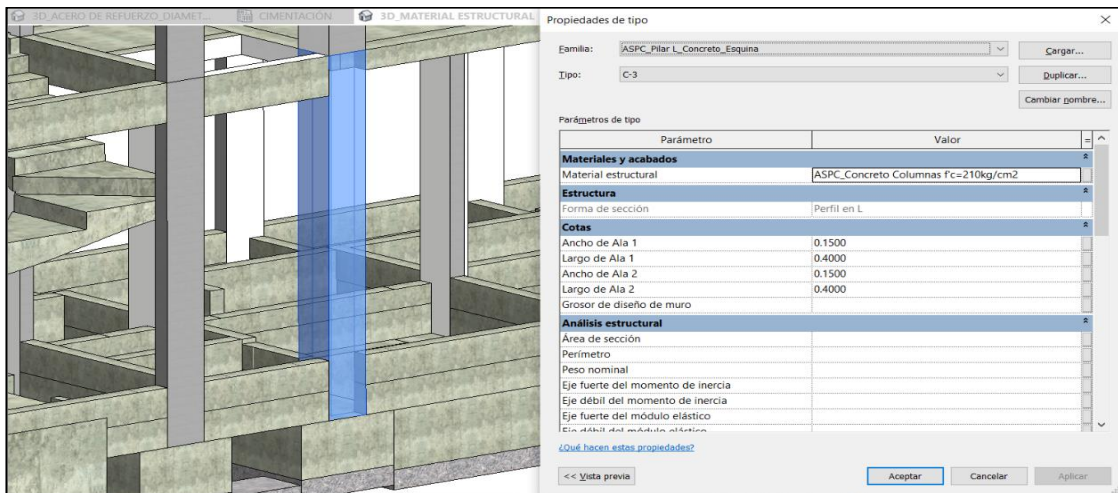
Visualización de Columnas de concreto en caja de sección en BIM
